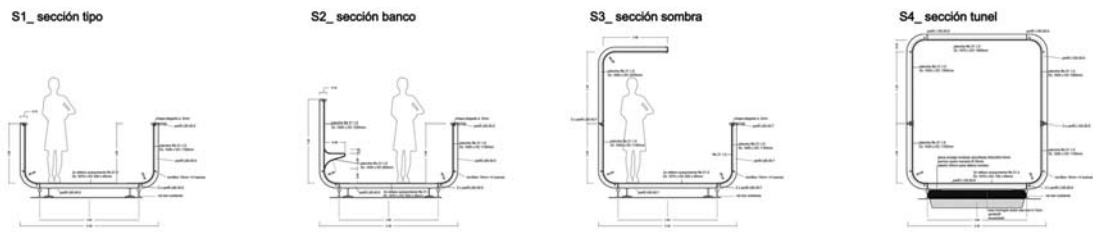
Detalles de proyecto de la intervención en las vías férreas.
